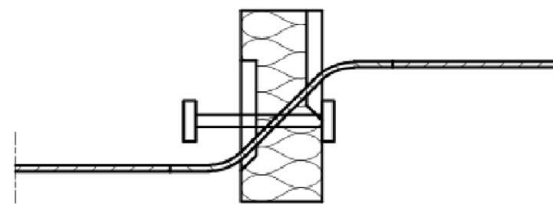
Schöck Isokorb® Typ Q-ID mit Stahldrucklager
